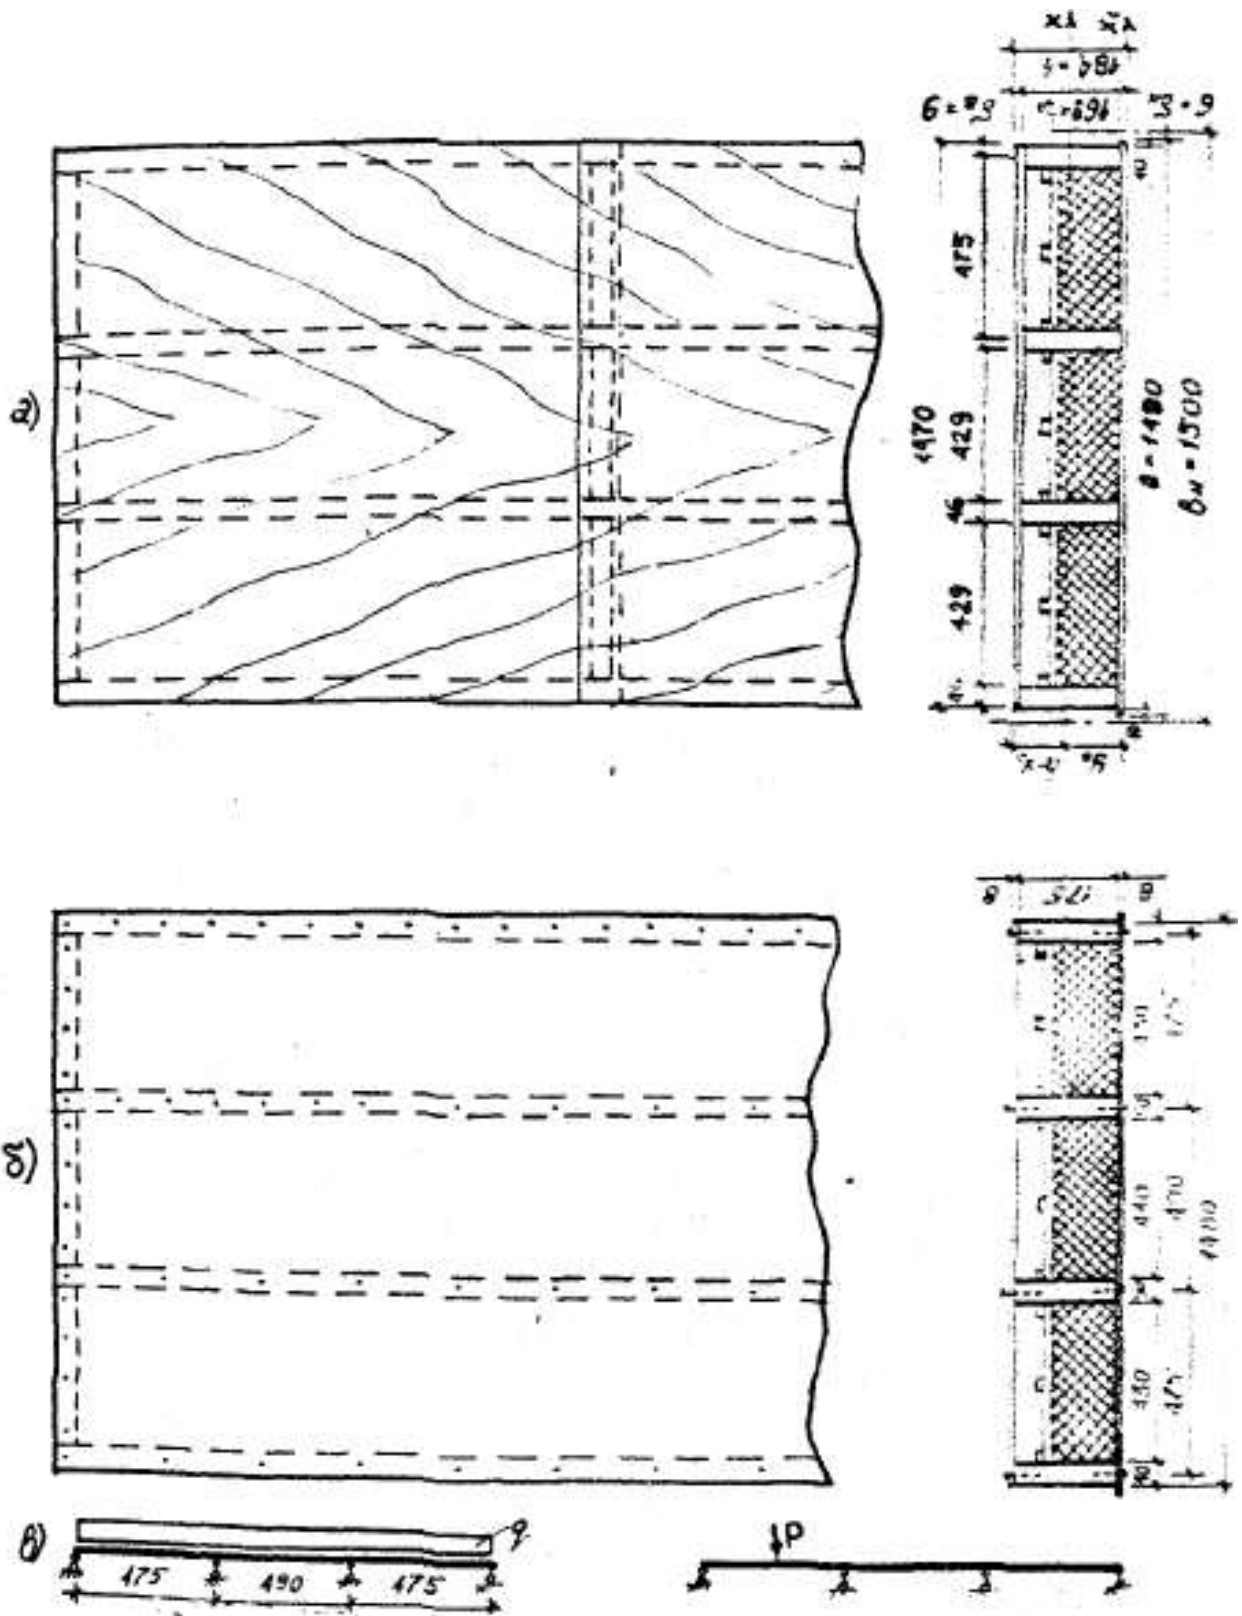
Утепленная плита покрытия (а - клефанерная, б - с обшивками из плоских асбестоцементных листов).
